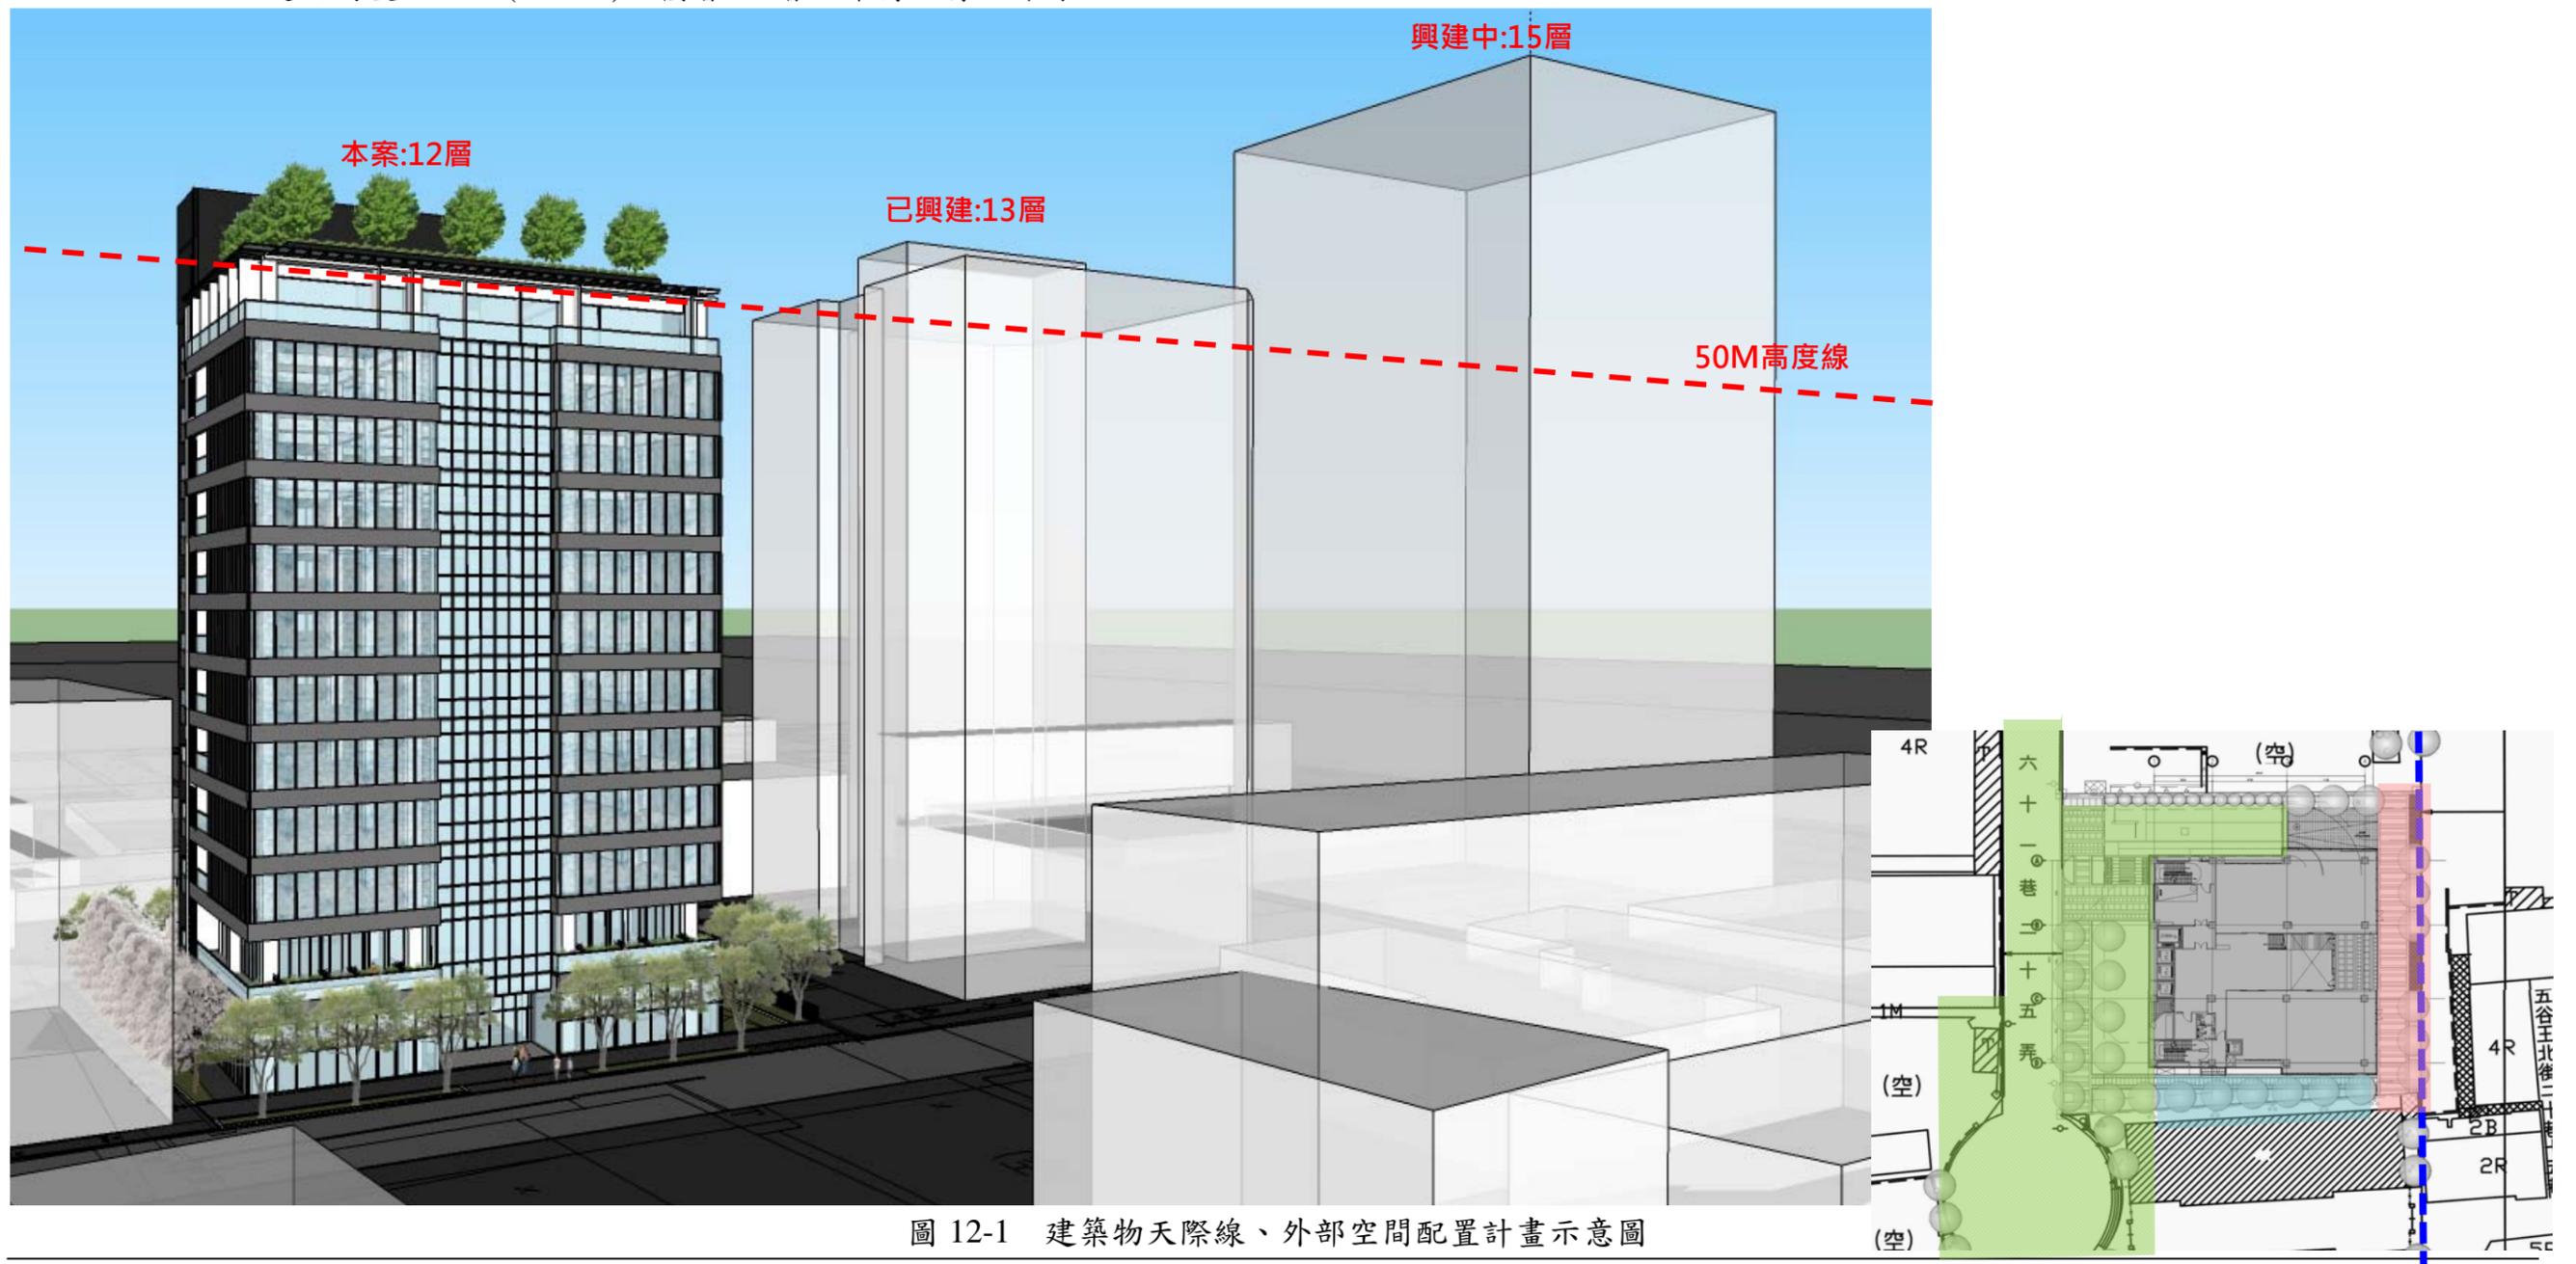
建築物天際線、外部空間配置計畫示意圖
